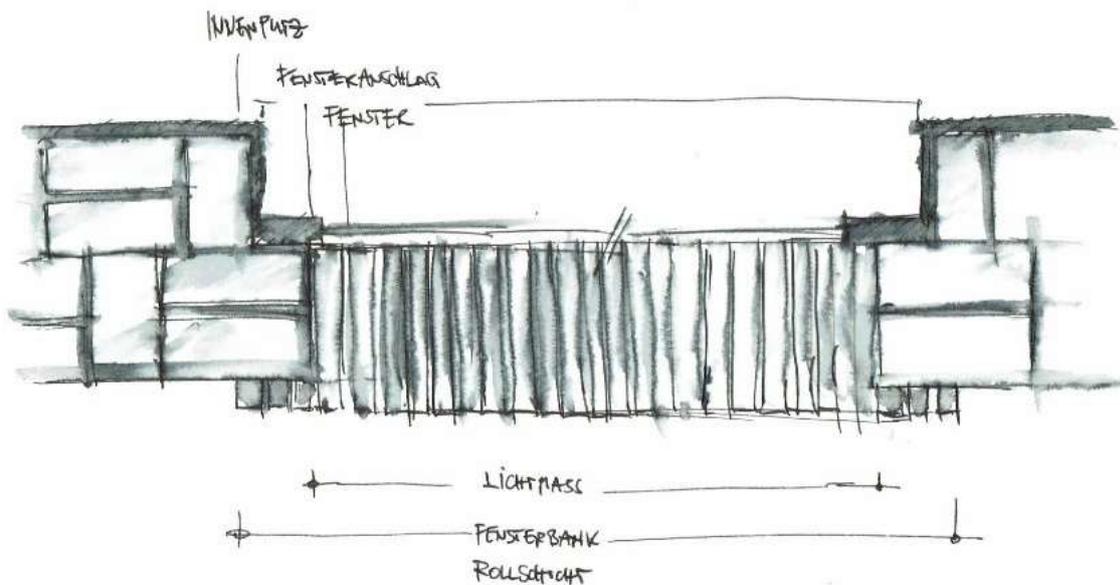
Skizze Detail Grundriss Fensterbank
